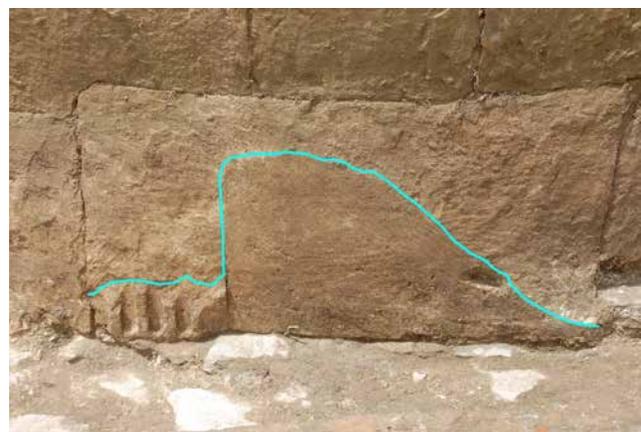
Detalle del retalle de la pieza con la lesena para adaptarla a la planta curva de la torre.
